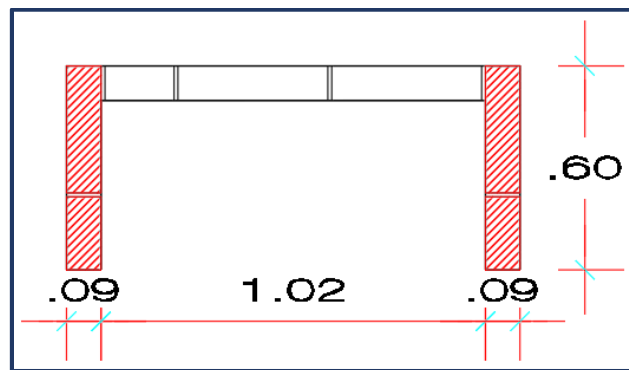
Esquema del Tipo 3 – Vista Planta.
